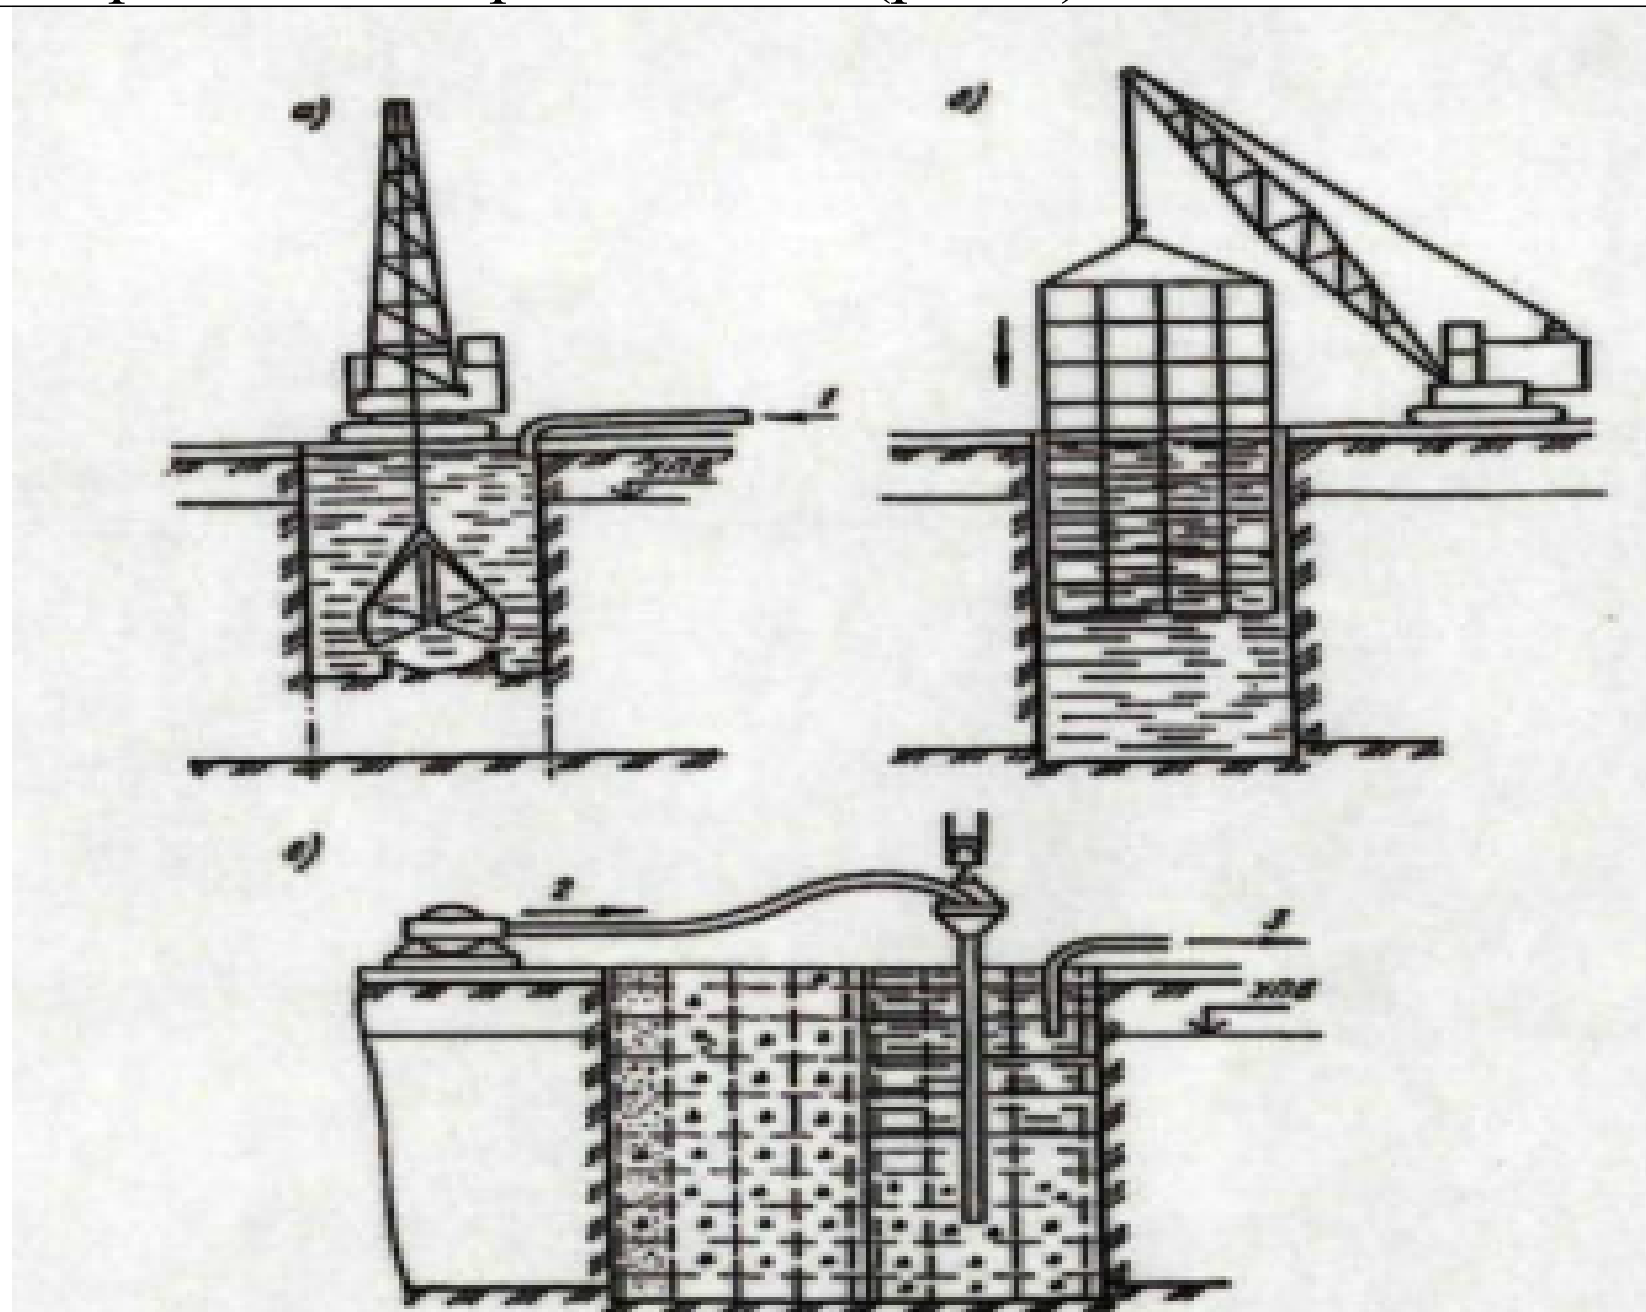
Технологічна схема виконання робіт при влаштуванні конструкцій з монолітного залізобетону: а - розробка траншей грейфер під захистом глинистого розчину; б - опускання арматурного каркаса; в - бетонування методом ТВП; 1 - подача глинистої суспензії; 2 - подача бетону; 3 - відкачування глинистої суспензії
